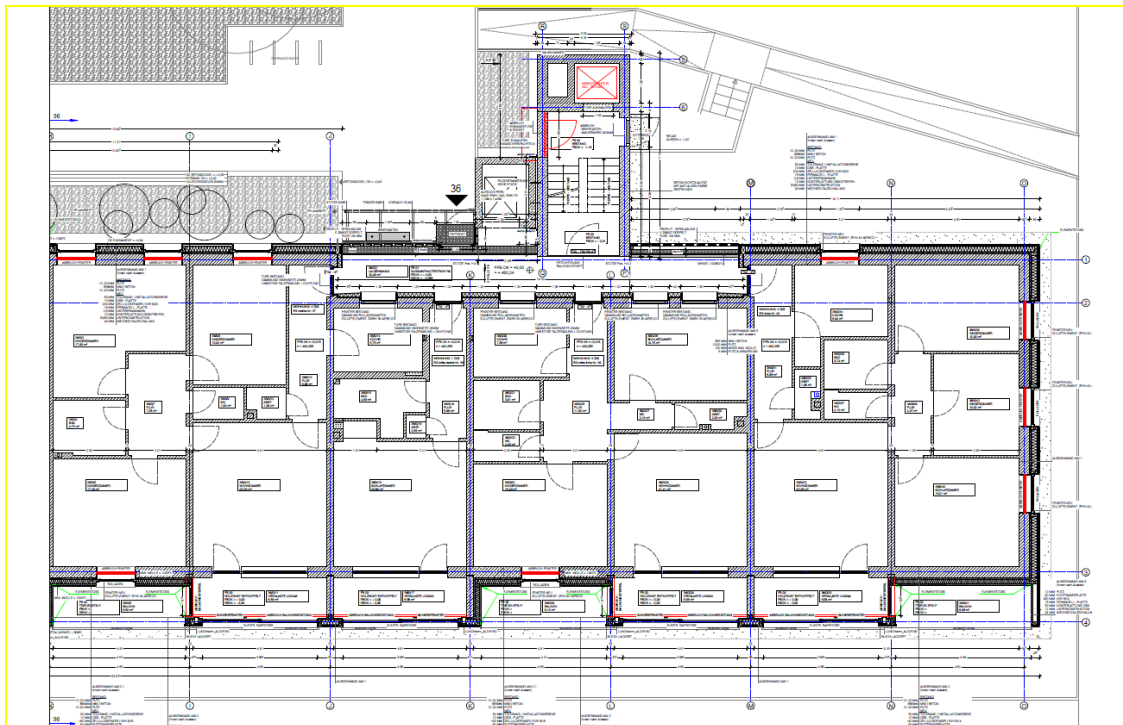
Wohnungsbau Augsburg Modernisierung Grundriss Ausschnitt
